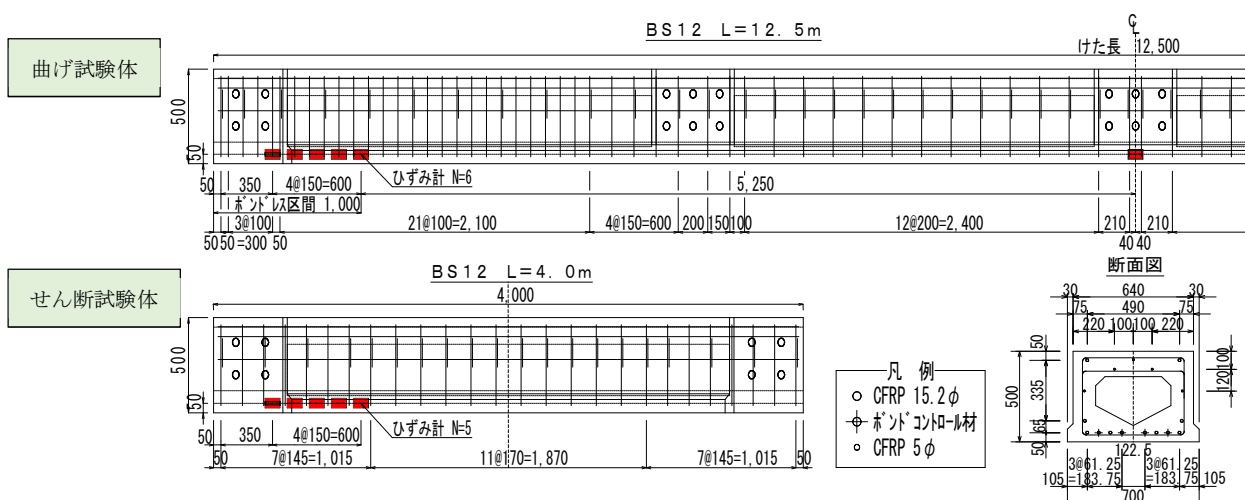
試験体の形状・寸法・補強材の詳細及び埋設型ひずみ計の設置状況
